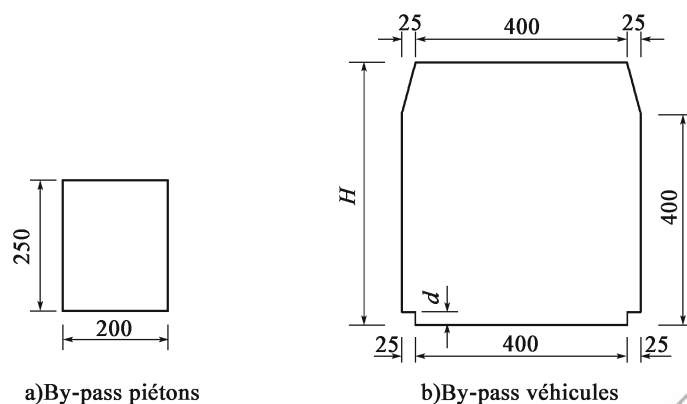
Dégagement de construction du profil du by-pass (unité: cm)
